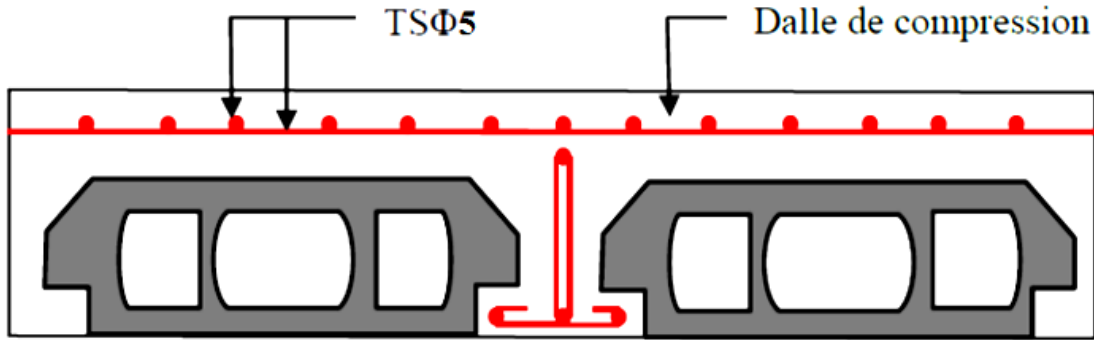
Disposition constructive des armatures de la dalle de compression
